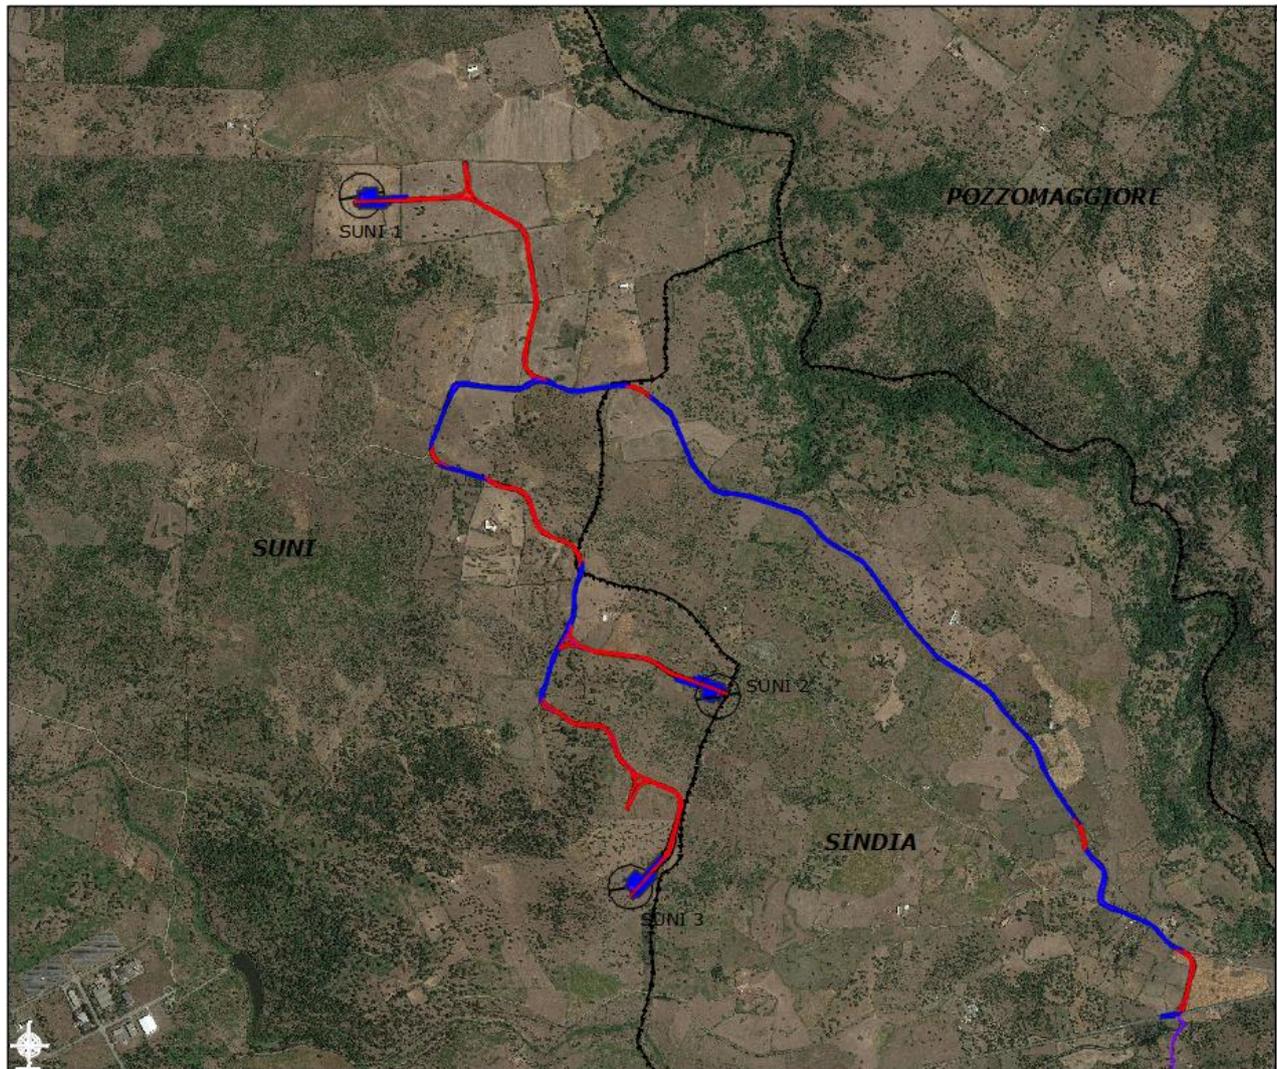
Primo inquadramento dell'ubicazione delle WTG, della viabilità di impianto e del cavidotto su base ortofoto
